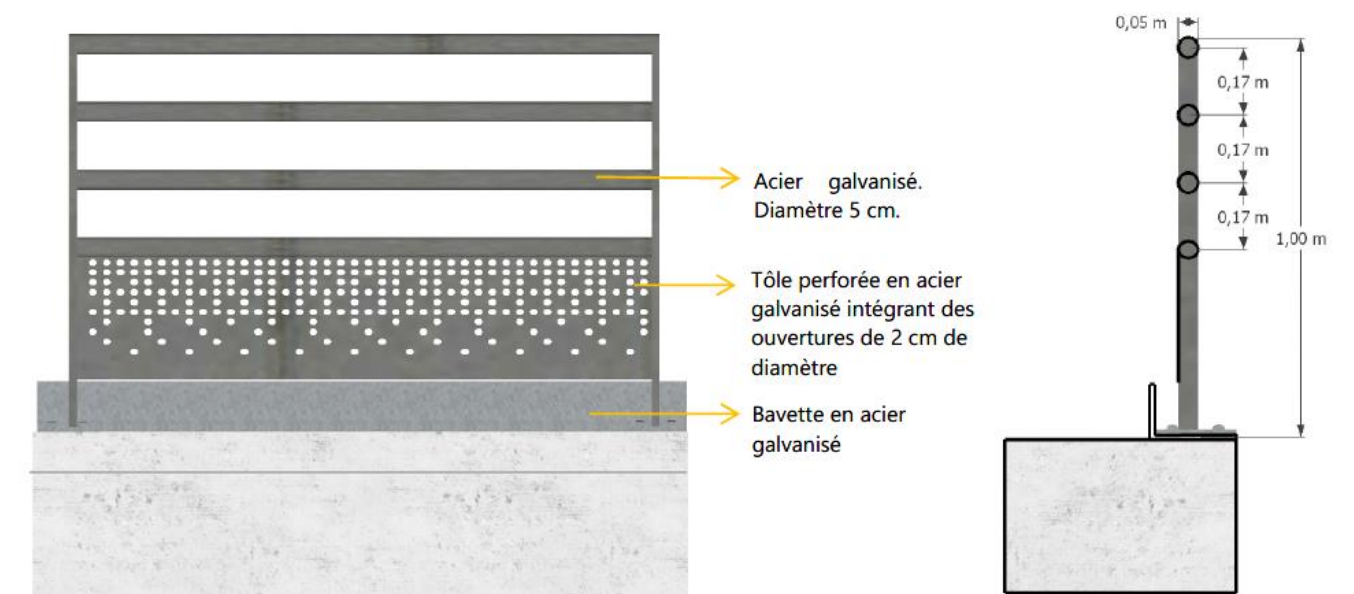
ÉLÉVATIONS ET COUPE DES GARDE-CORPS
